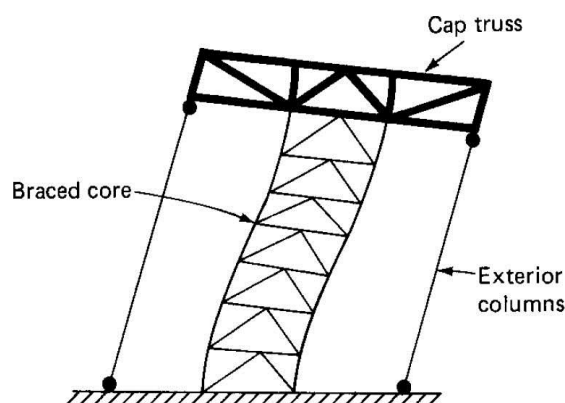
Sistema *Outrigger* - adotado de (CTBUH, 1995)
